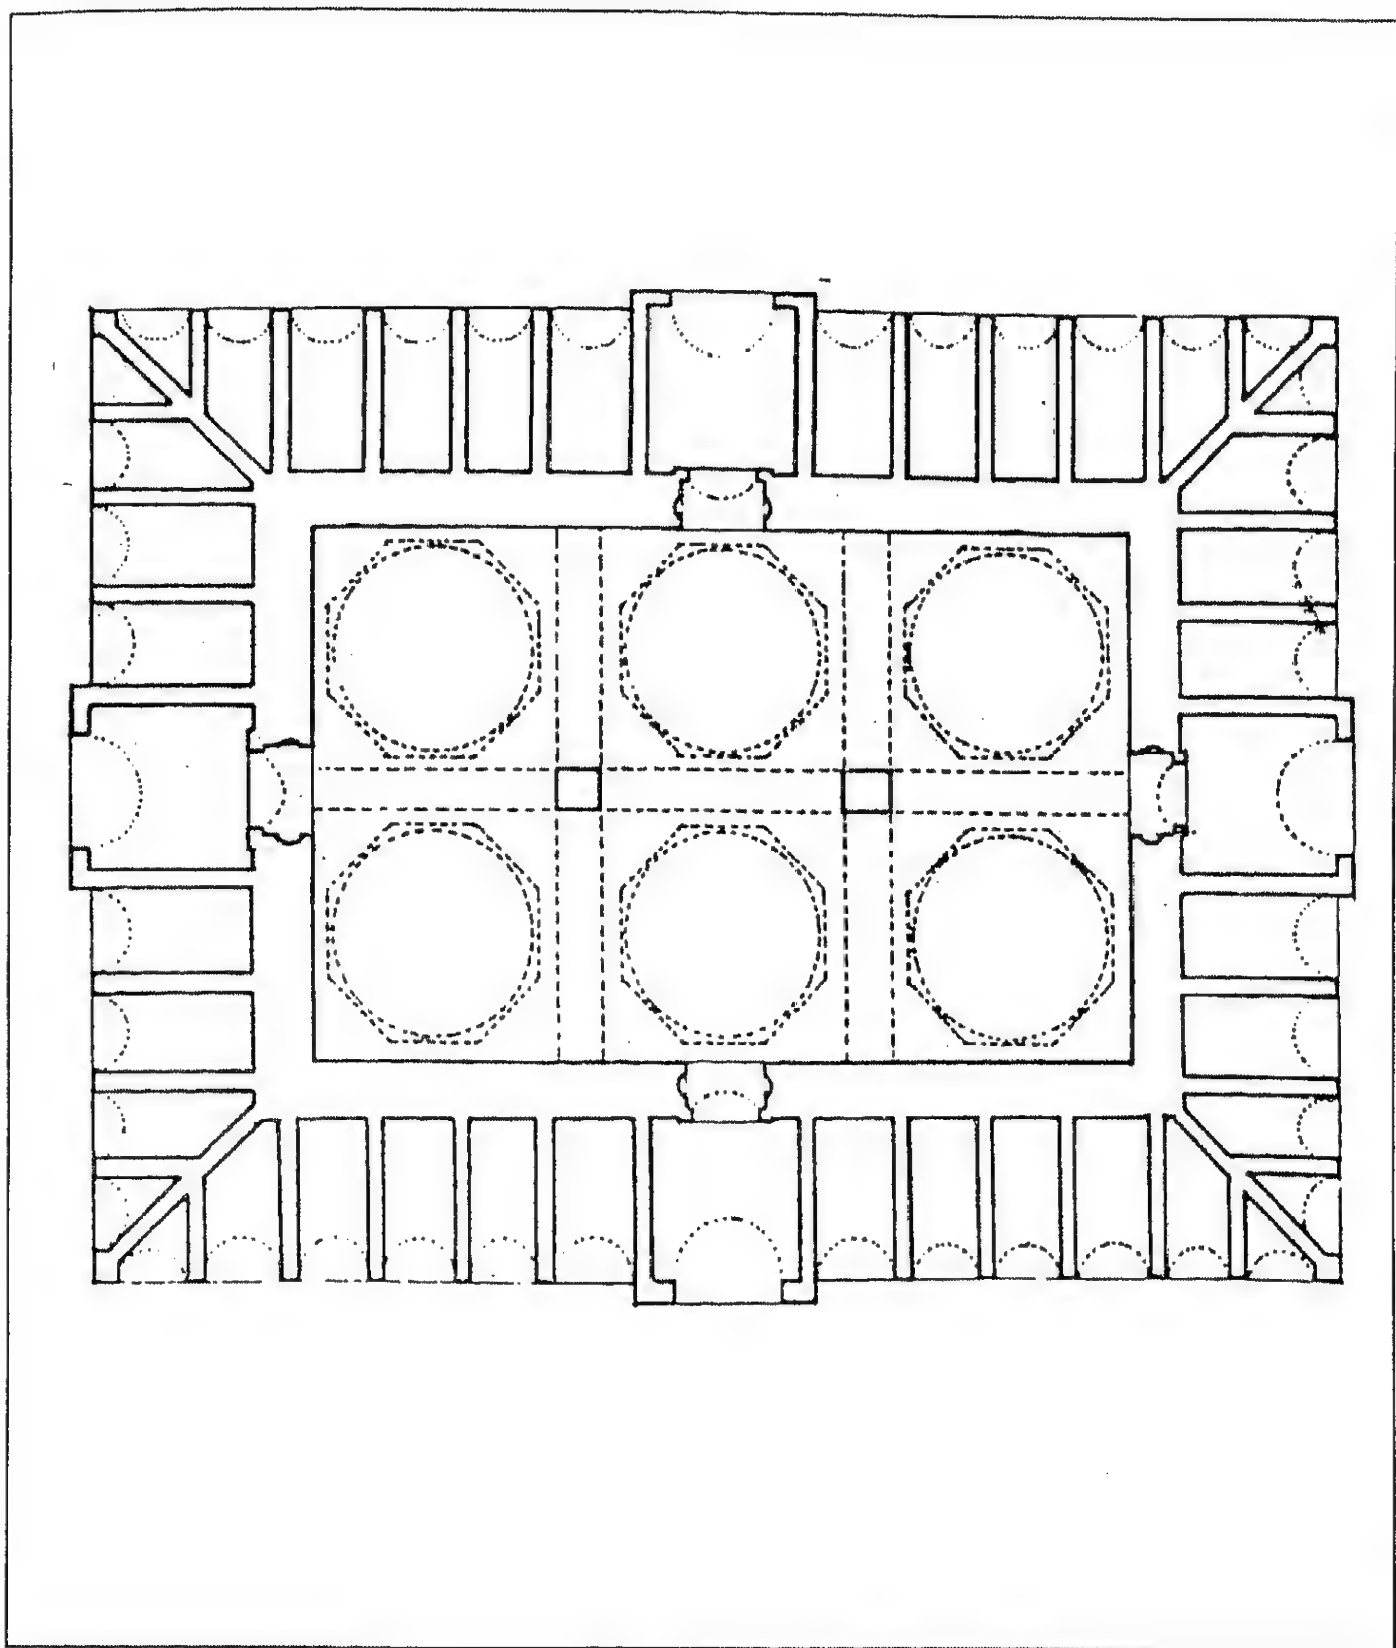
مسقط أفقي لصندل بادستان بإستانبول (عن: Cezar).
